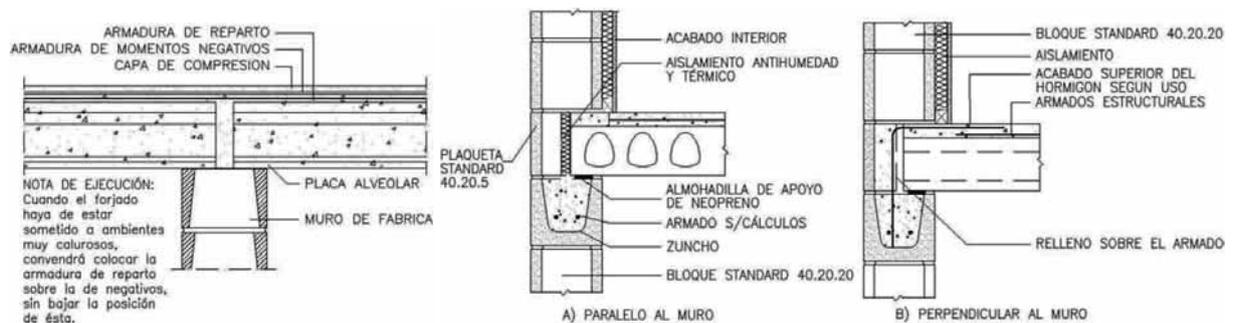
Forjado de placas alveolares sobre muro de bloque de hormigón hueco.
